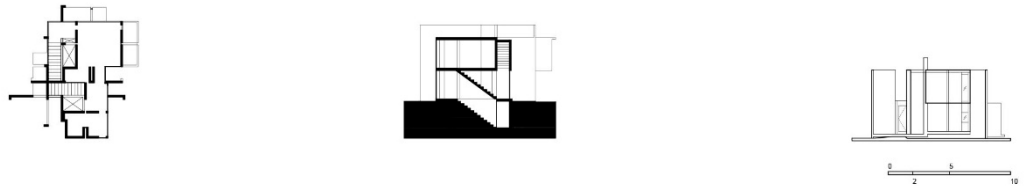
Redesenho da planta, corte e elevação – Casa VI
